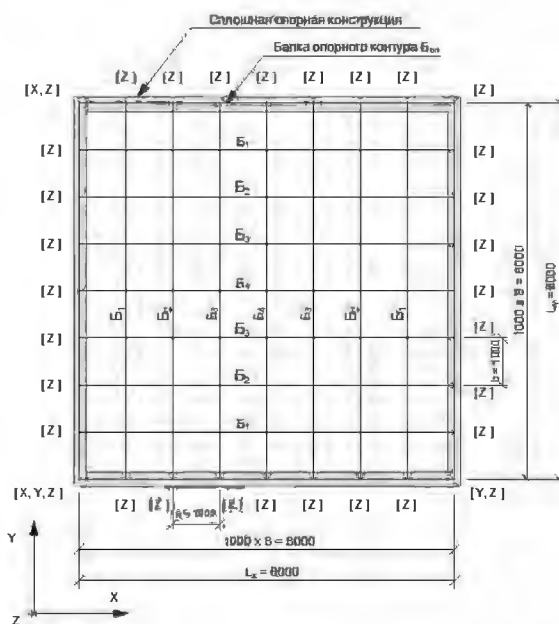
Схема кессонного перекрытия: B_1, B_2, B_3, B_4 – рассчитываемые балки; $[X, Y, Z]$ – связи, установленные в узлах балки опорного контура
